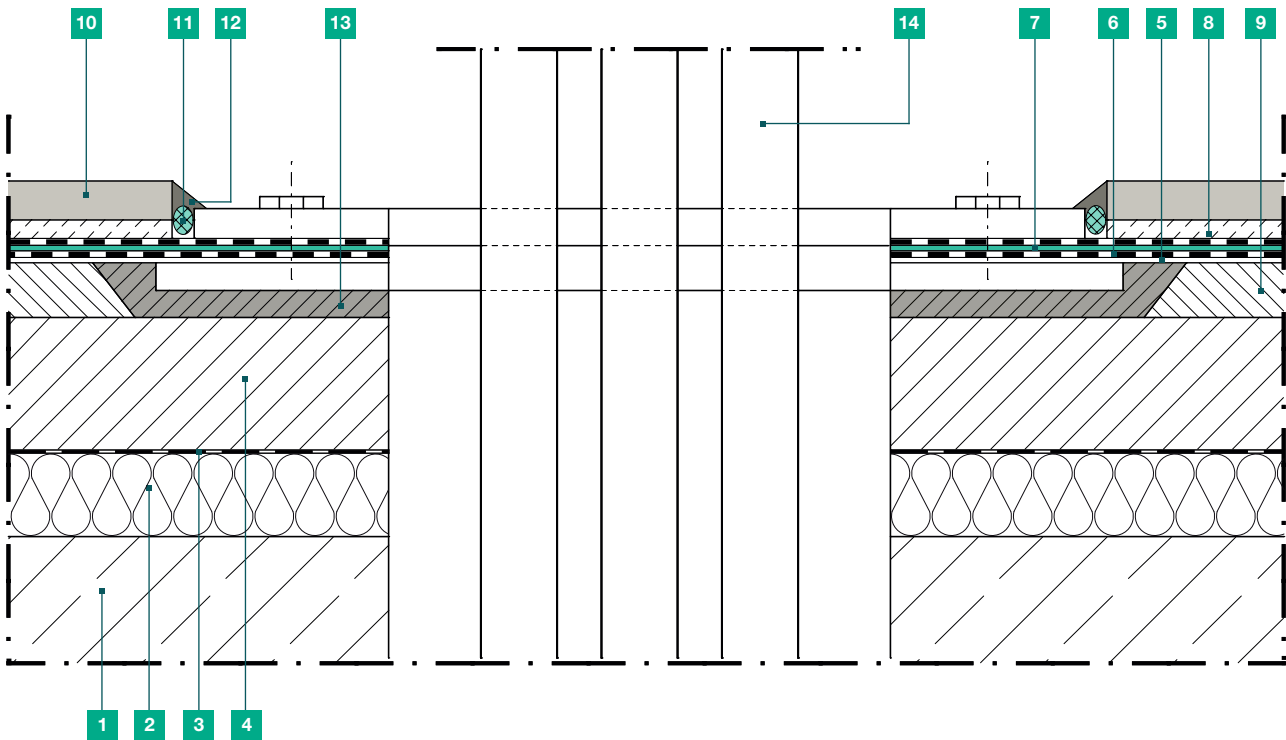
Anschluss an Edelstahl-Durchdringungselement - Abdichtung mit DICHT PA - hohe chemische Beanspruchung
